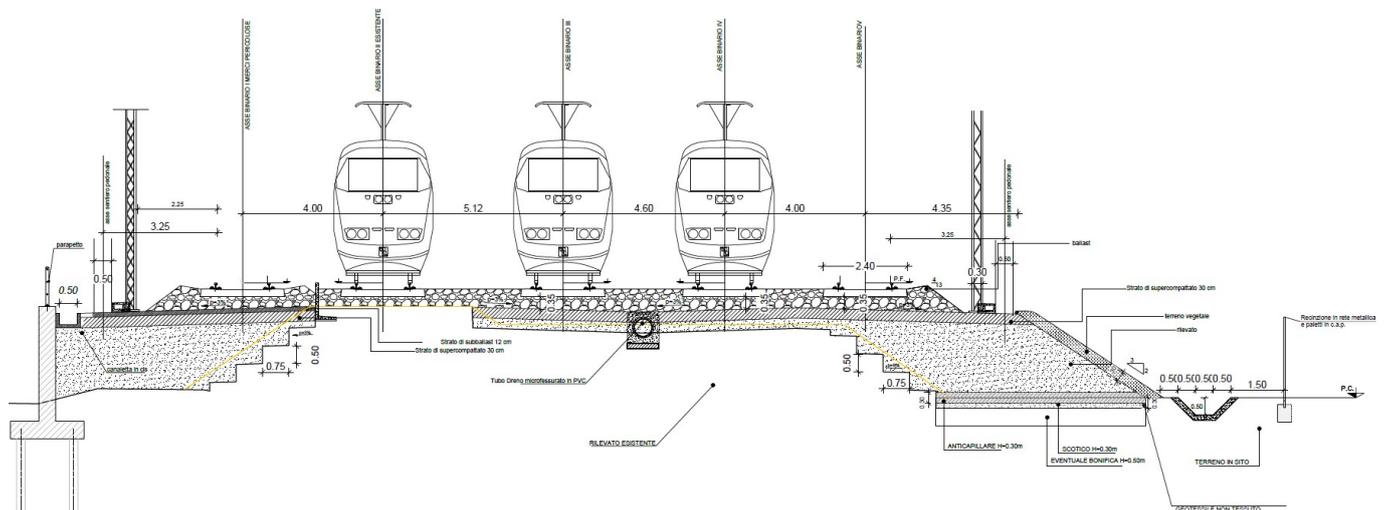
RI03 – Sezione caratteristica lato Savona
